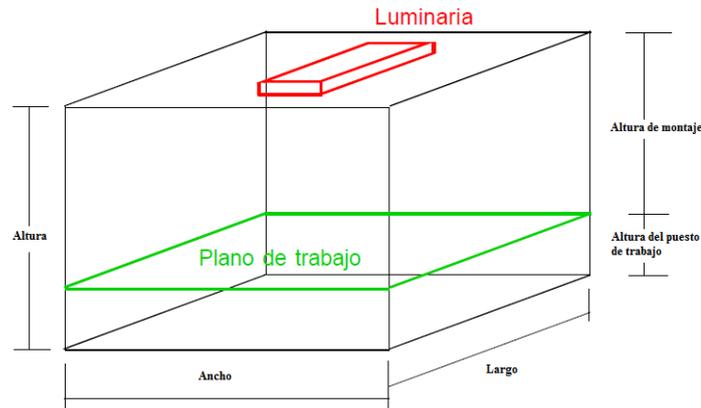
Distribución de las luminarias y plano de trabajo en una instalación.
